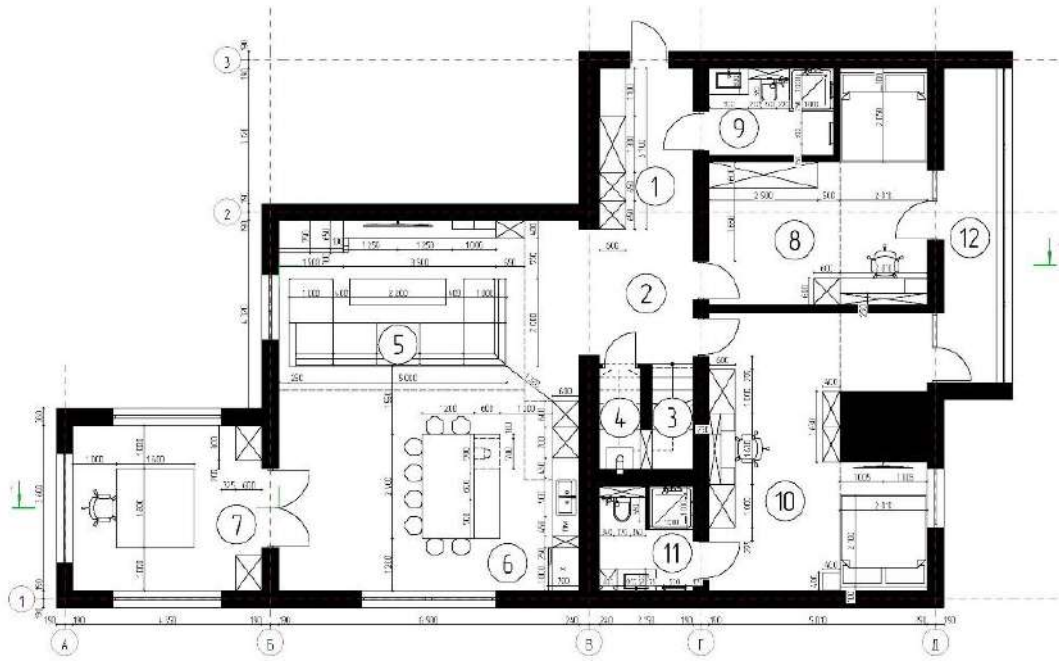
Планувальне рішення для 1-го поверху квартири (авторське креслення).
